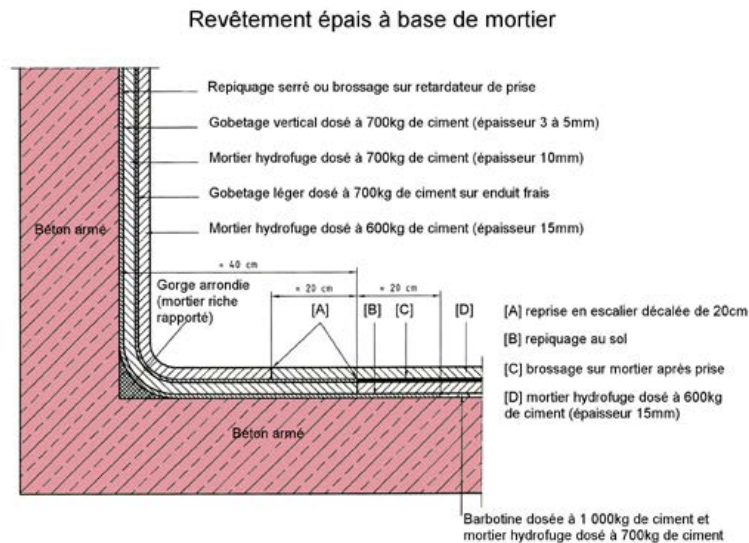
cuvelage avec revêtement épais en mortier (extrait de la norme-DTU 14.1)
